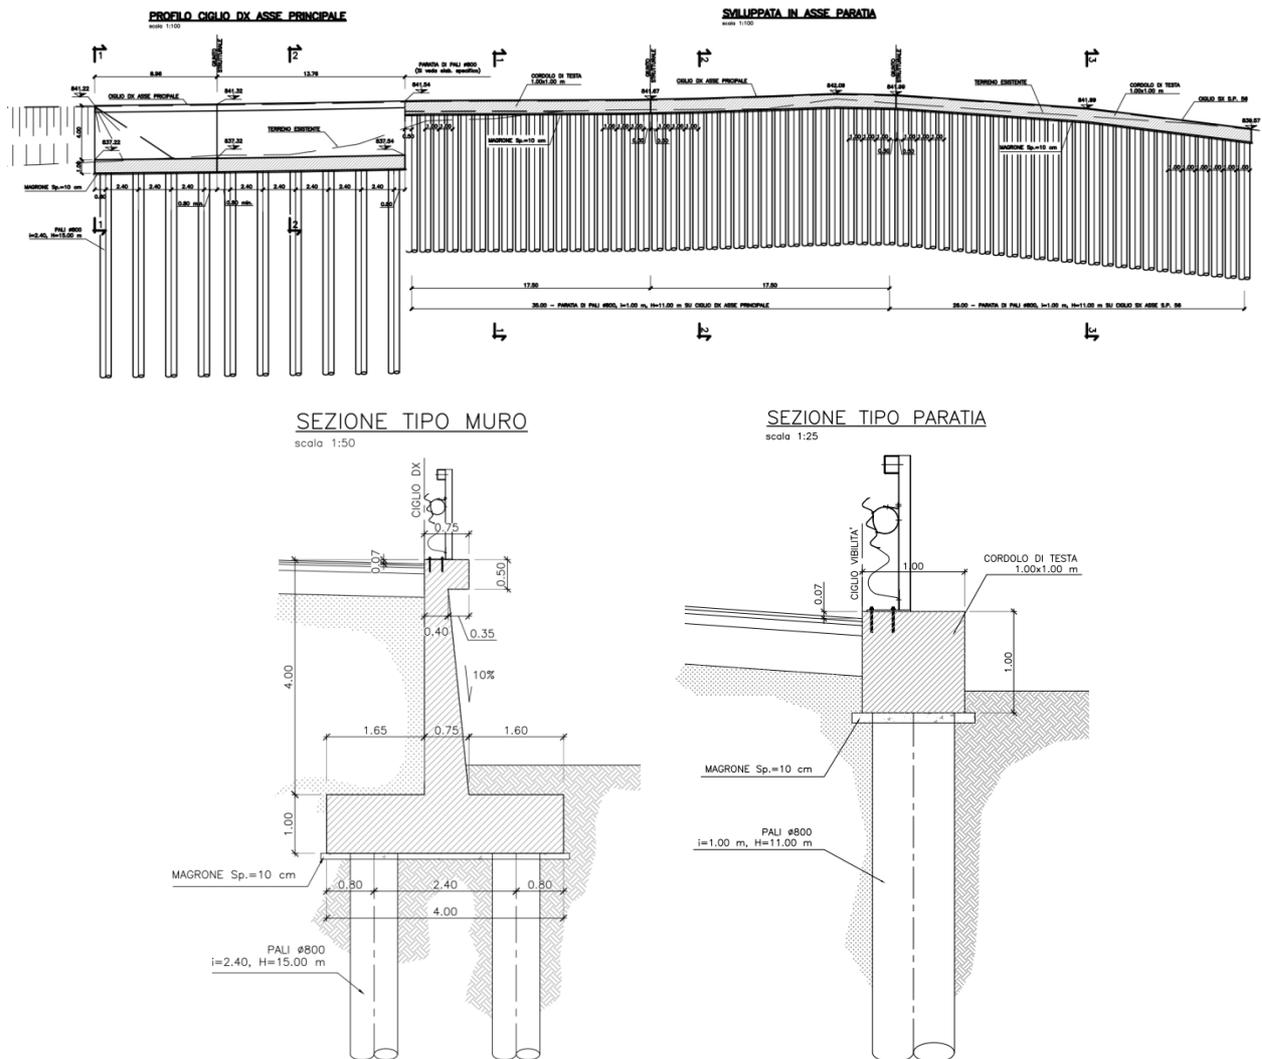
Profilo e sezioni tipo del muro su pali e della paratia
